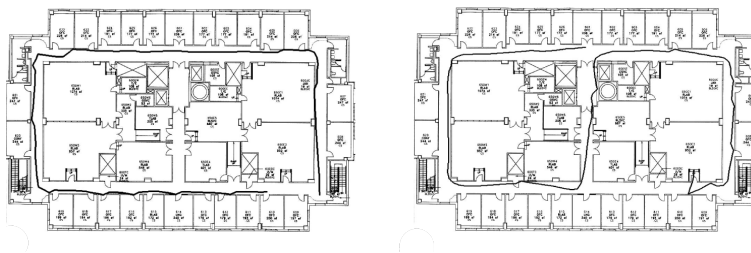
Plano del edificio donde se aplica el sistema de posicionamiento móvil
